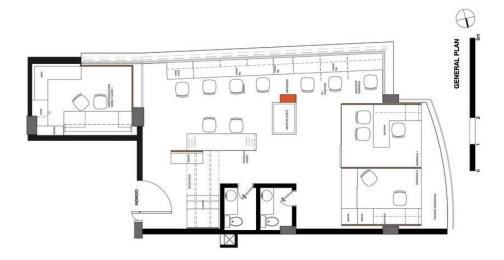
Planta Arquitectónica. Tomado de (Arquitectura, 2010)
